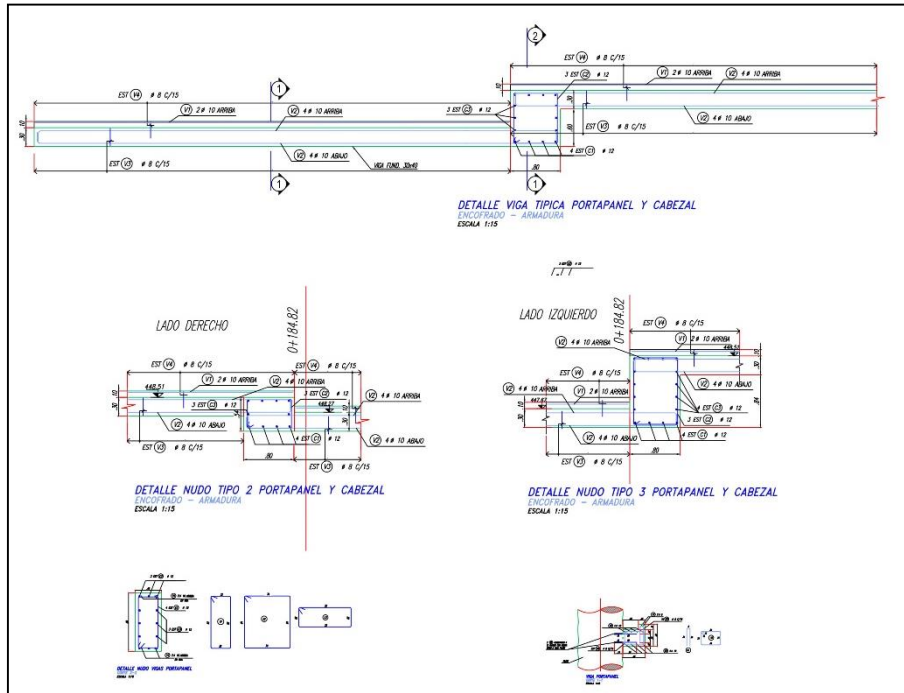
Detalle viga portapanel. (PLANO N° 32)
